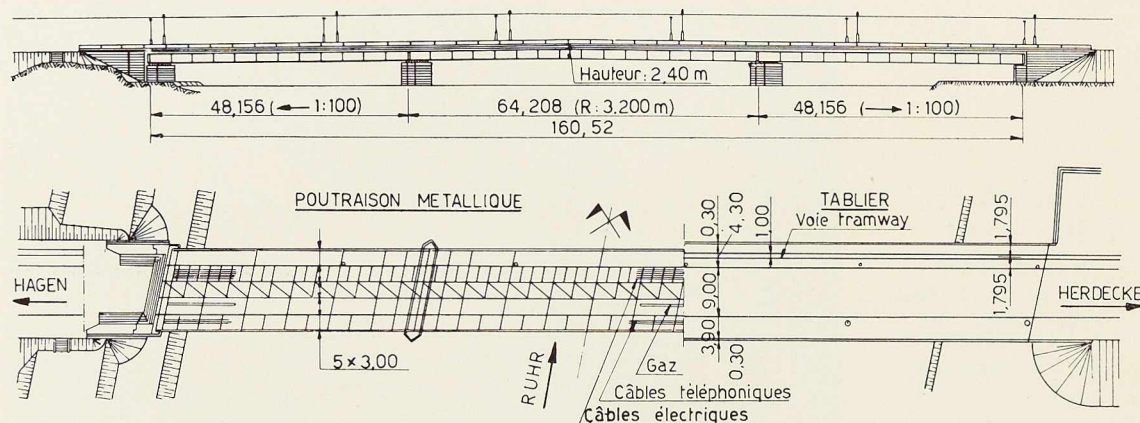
Elévation et vue en plan du pont de Herdecke sur la Ruhr.
